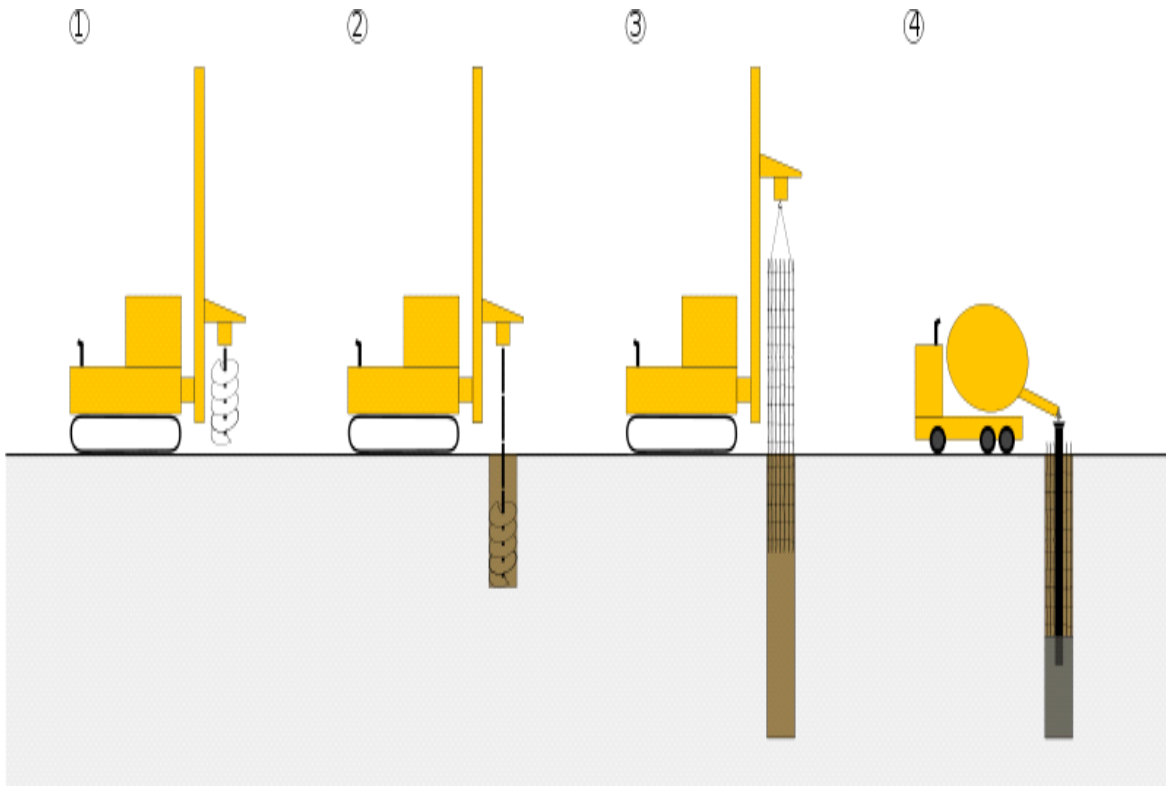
Perforación y colocación de armado de pilote colado en el sitio.
